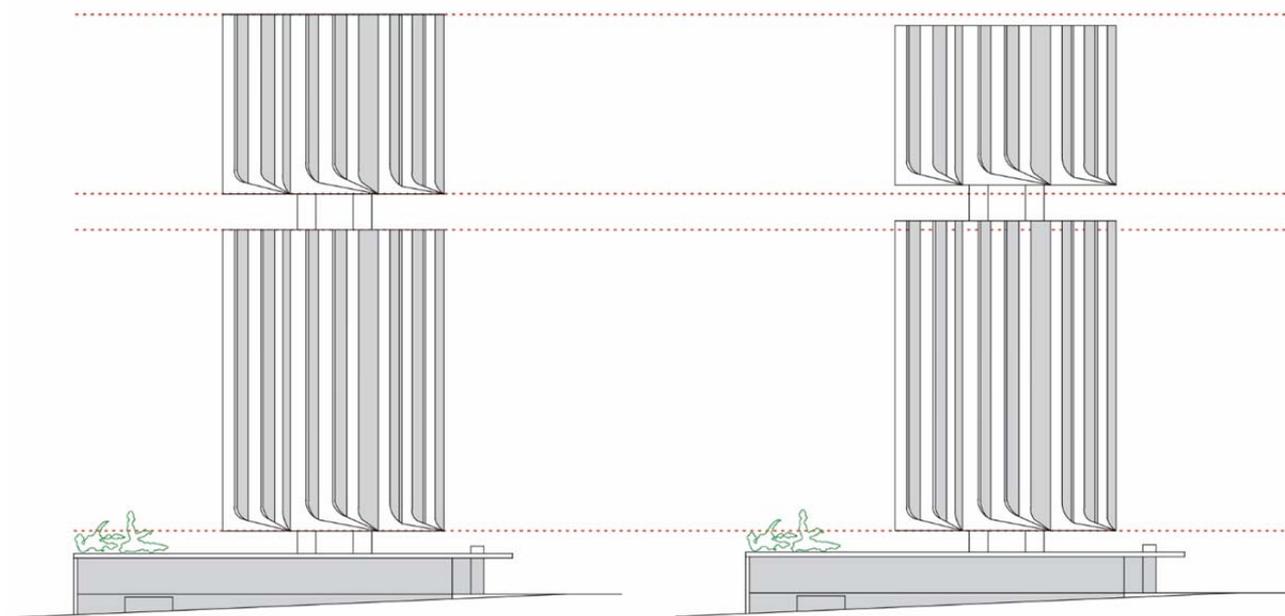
Comparativo – elevação do estudo preliminar X elevação com solução estrutural aplicada
